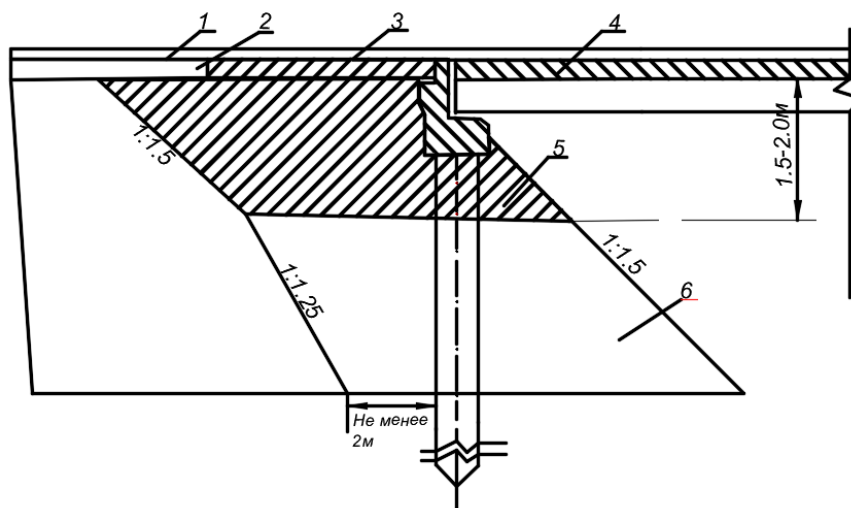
Конструкция земляного полотна на подходе к мосту и конусов, возводимых из цементогрунта при высоте насыпи до 3 м
